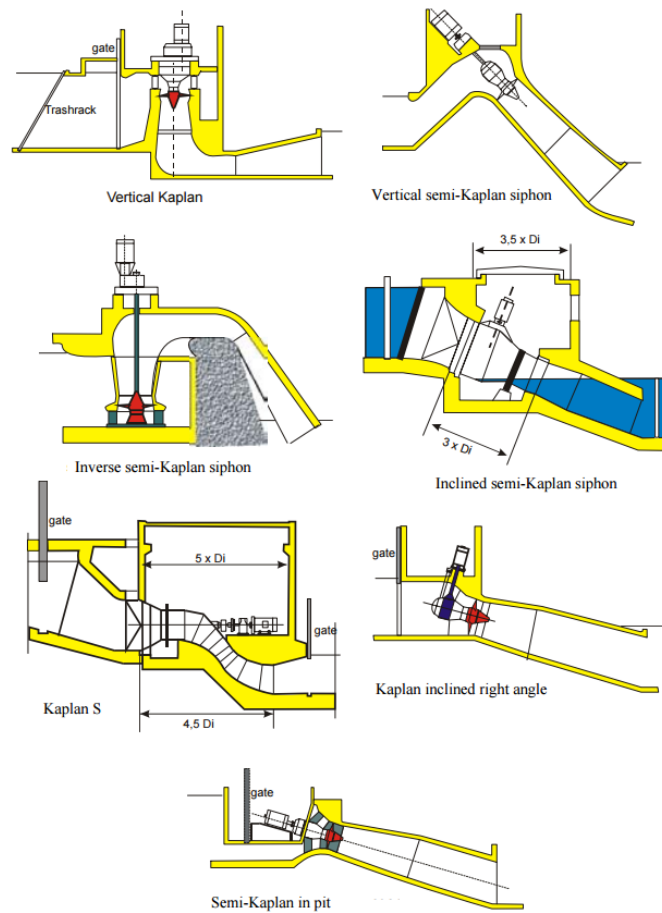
Possíveis configurações com turbina Kaplan. Adaptado de [12].
